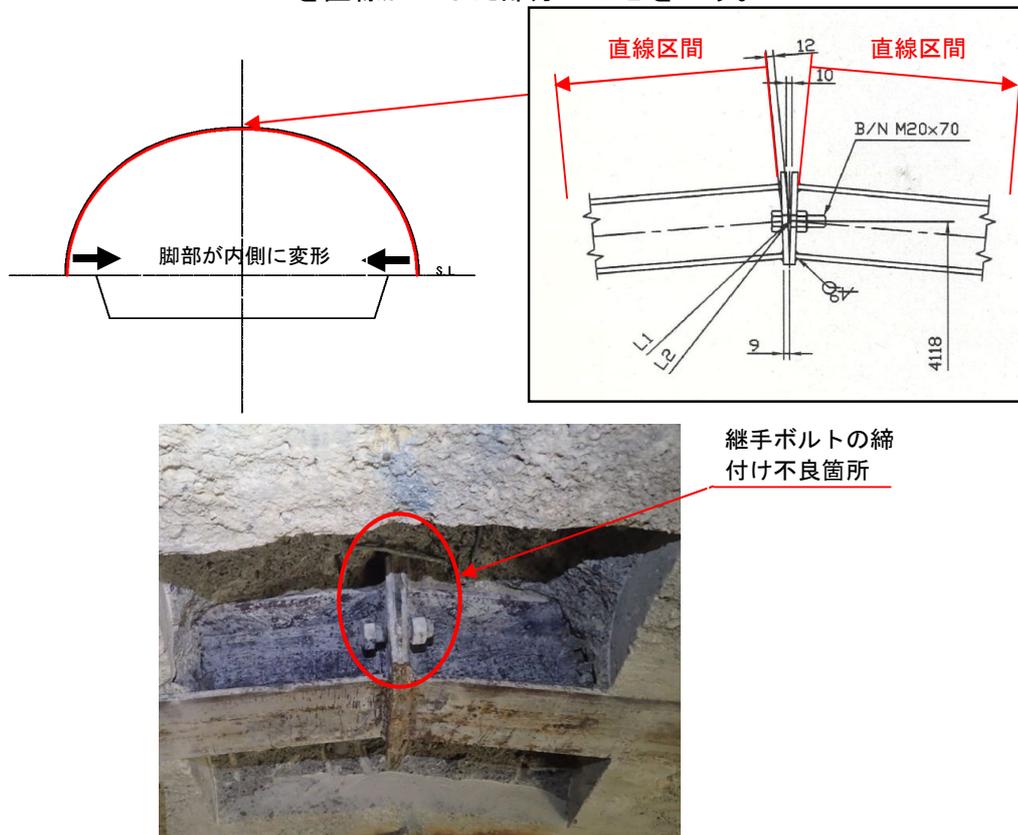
鋼アーチ支保工の天端継手部の位置、構造図、施工写真
